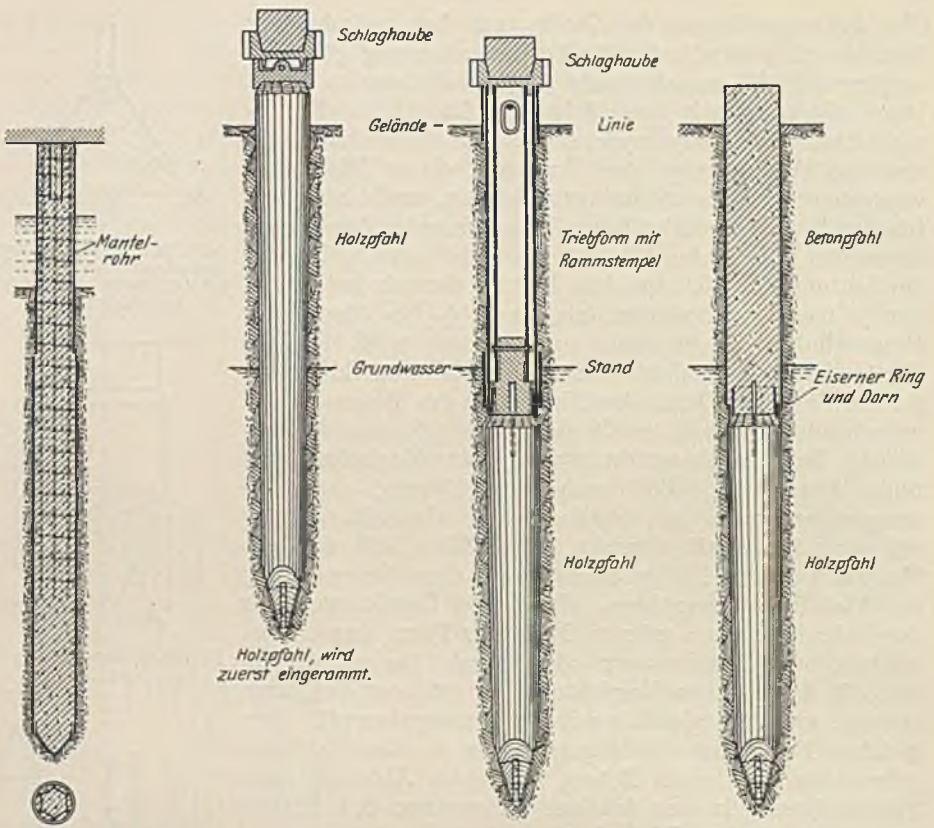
, Simplexpfahl mit Eisenbewehrung und zurückgewonnener Form.
